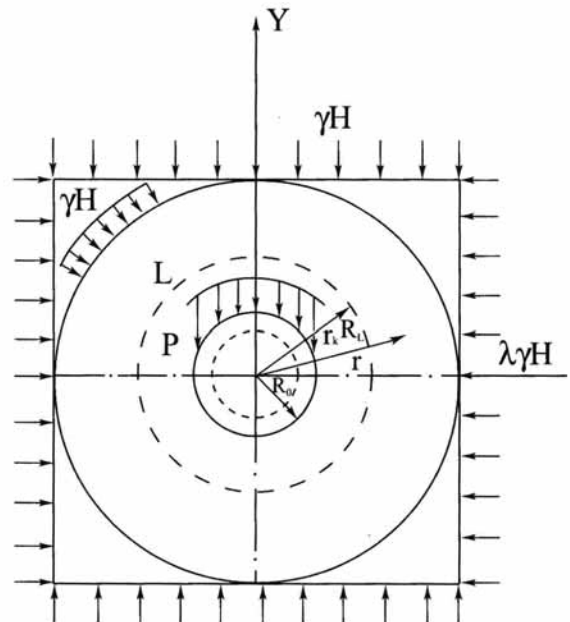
Схема к определению нагрузки на податливую крепь горной выработки
